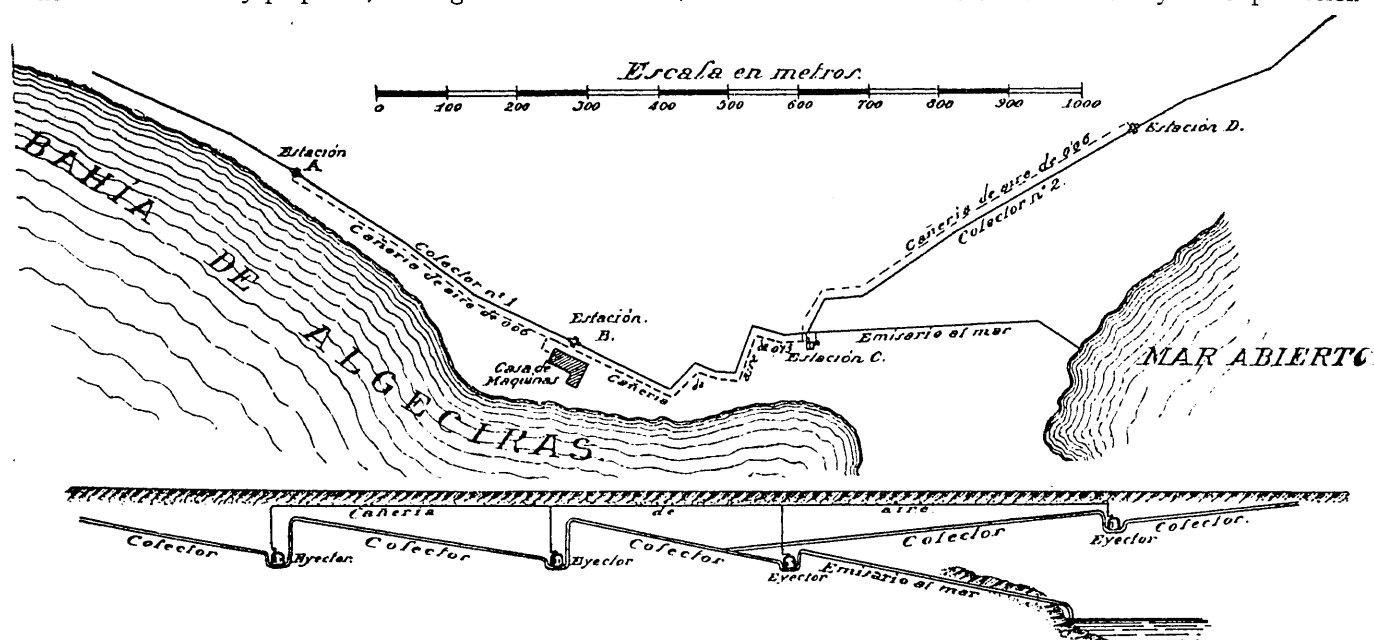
ª.—Esquema de planta y perfil longitudinal.
